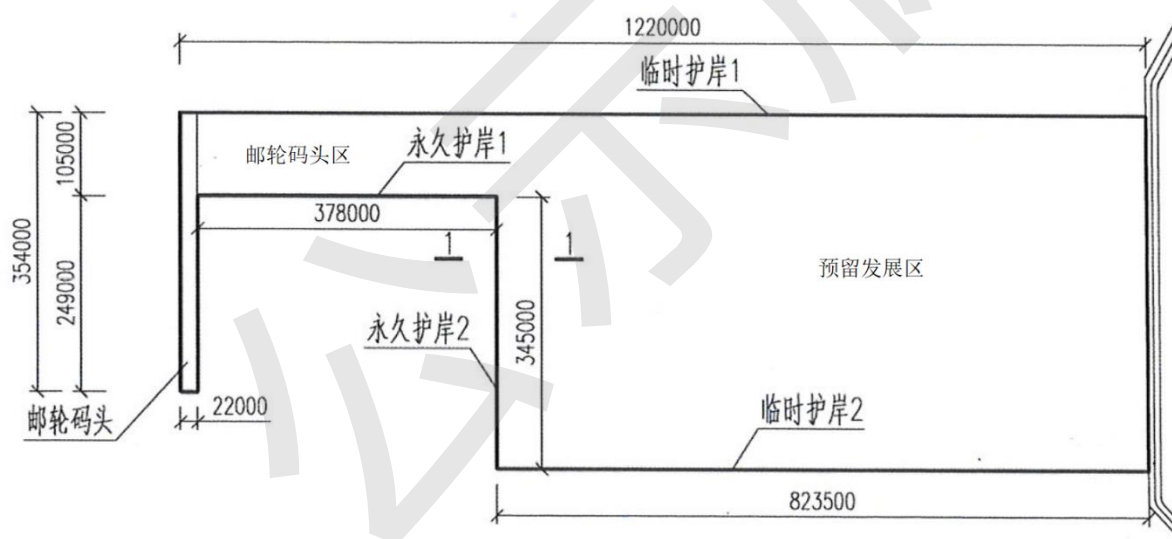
北海邮轮码头工程码头、护岸平面尺度示意图
